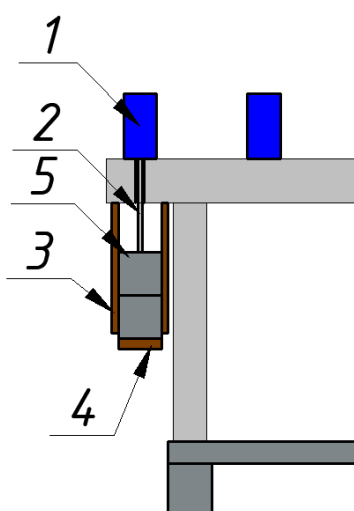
Опускание горизонтальной палубы с двумя слоями бетона
